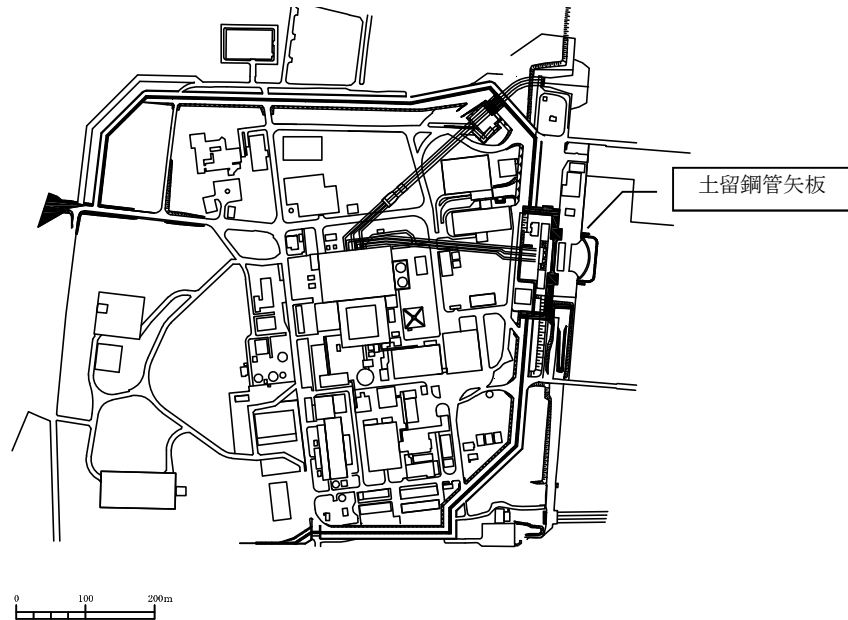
(1) 土留鋼管矢板の平面配置図 (全体図)
